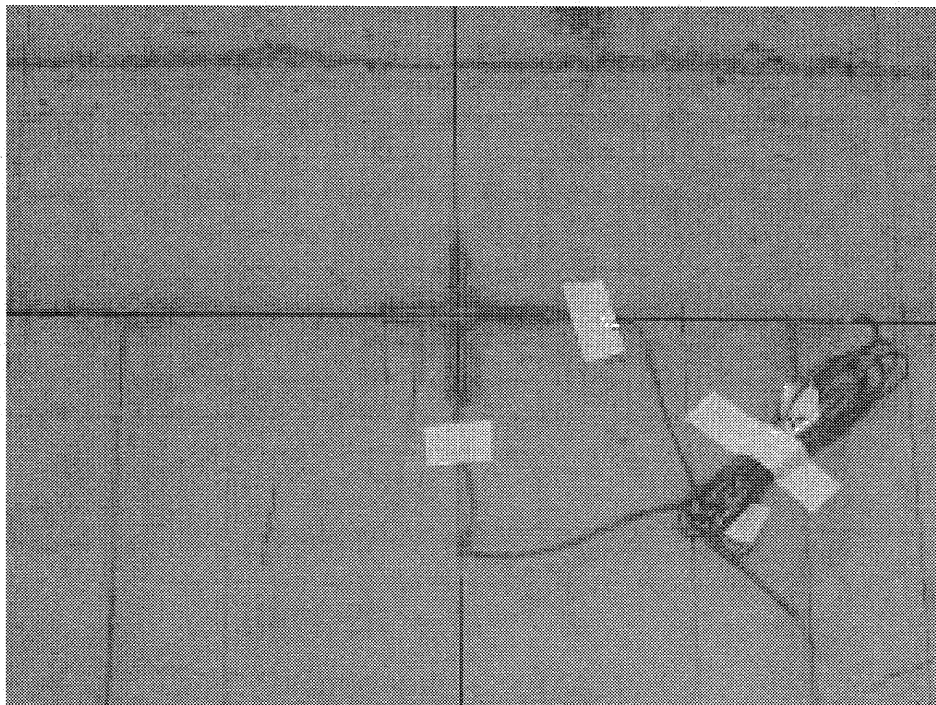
コンクリート表面へのひずみゲージ貼付状況
